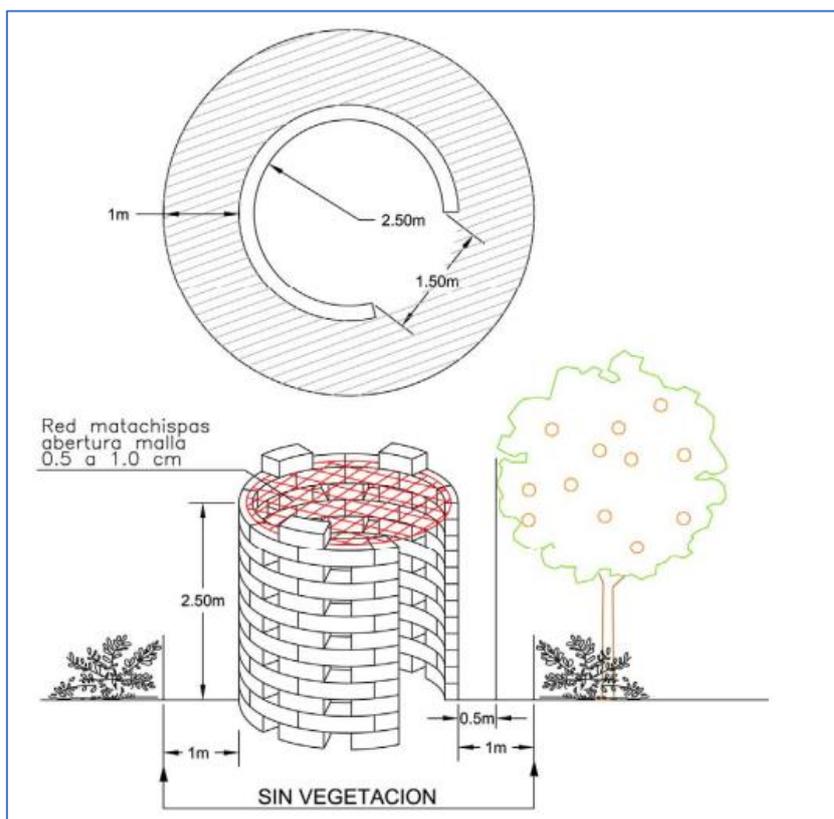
Planta y alzado de un quemador debidamente acondicionado. Fuente: Norma Técnica de construcción de quemadores agrícolas
